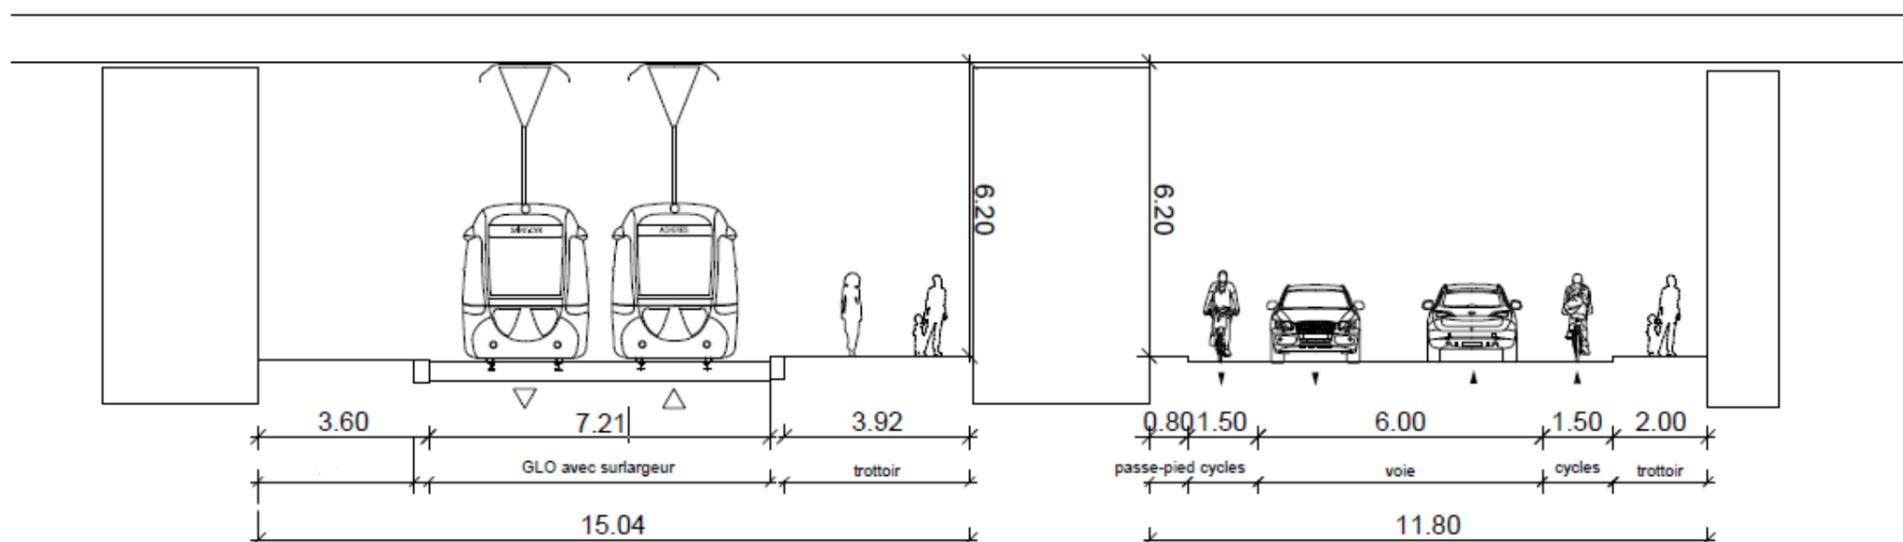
Principe d'insertion du passage sous le pont ferroviaire de la RD 190 avec l'ouvrage existant à gauche et le nouvel ouvrage à droite
